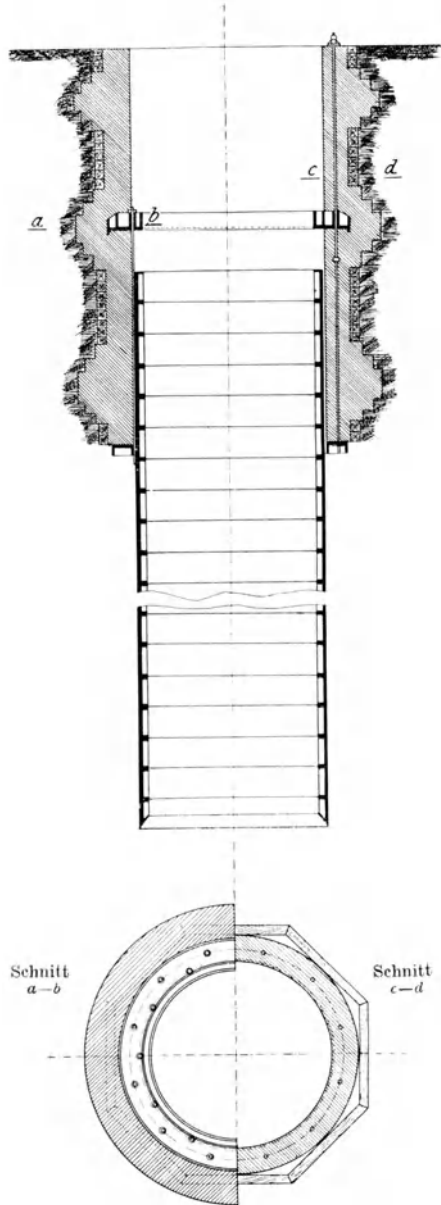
Führungsschacht mit äußeren Verstärkungsrippen.
